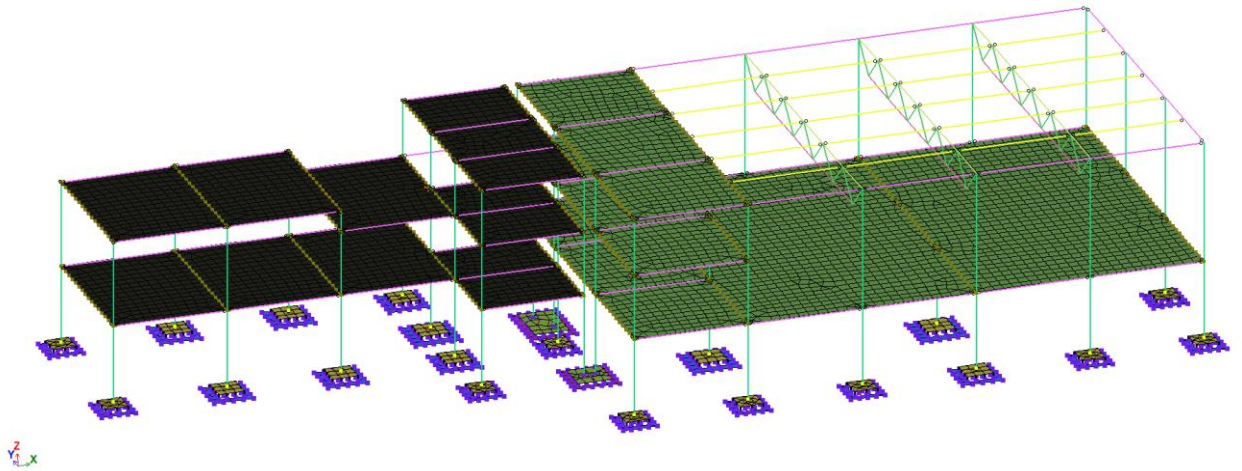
Розрахункова схема будівлі при фундаментах мілкового залягання
